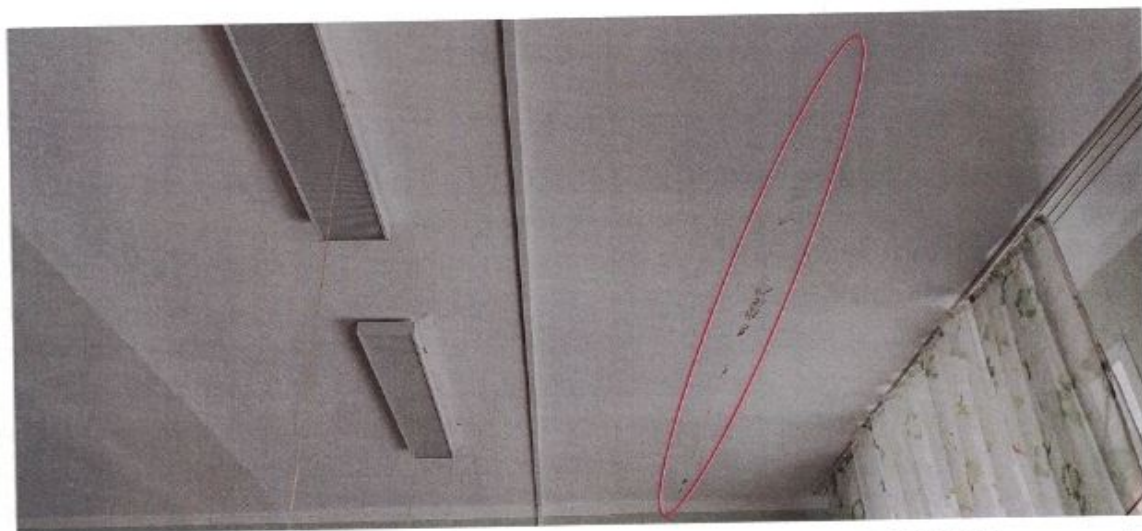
Трещины и отслоение межплитных швов перекрытия
